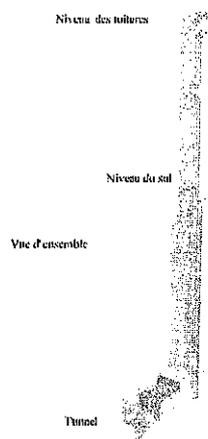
Disposition du puits Ozanam dans l'hypothèse d'un rejet au niveau des toits
